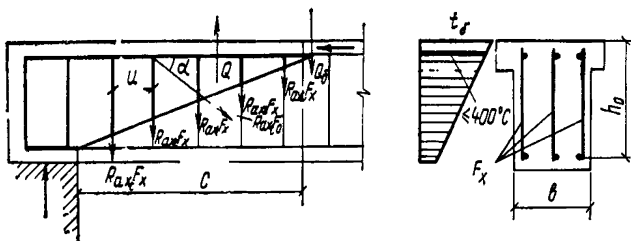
Схема усилий в сечении, наклонном в продольной оси железобетонного элемента при расчете его по прочности на действие поперечной силы
